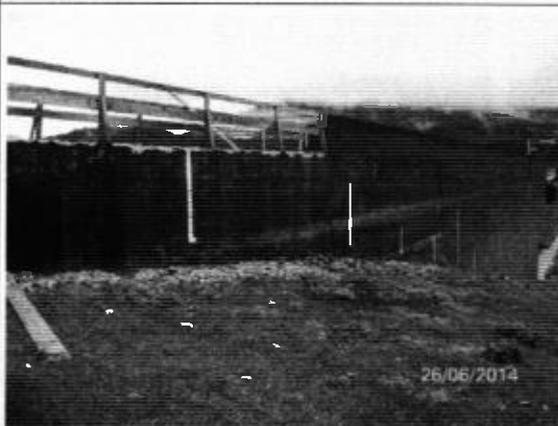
\_6362: Paramento de montante em obra de sobre-elevação.
